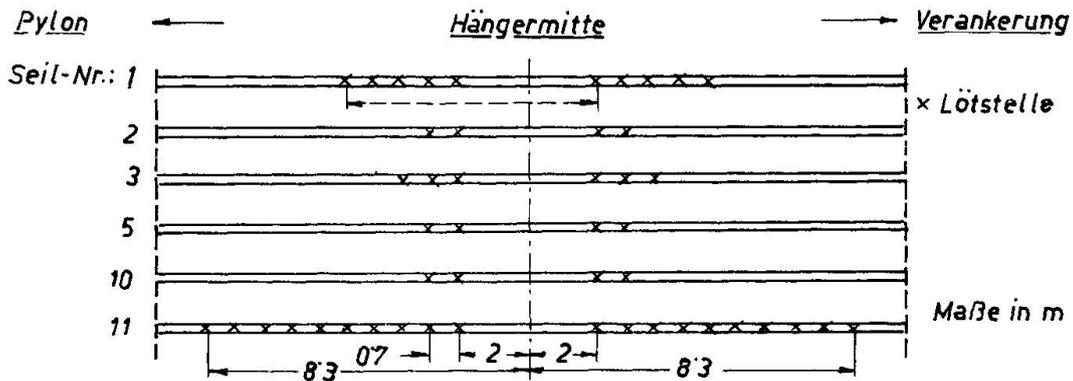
Lötstellenplan zur Sanierung der verschlossenen Tragseile im Bereich einer Hängerklemme
